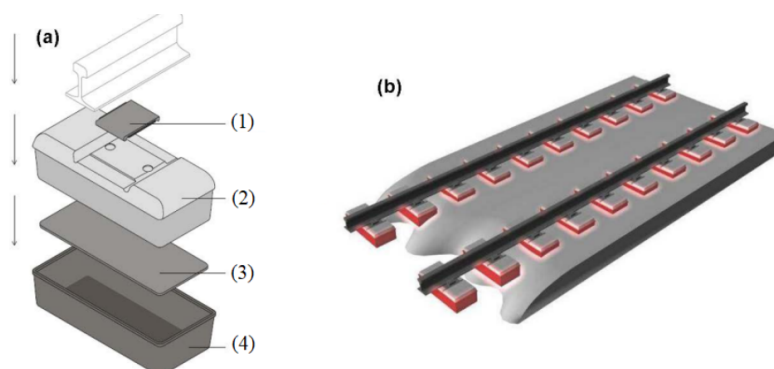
a) Système de support constitué de (1) semelle sous rail, (2) blochet, (3) semelle sous blochet, (4) chausson en caoutchouc. (b) Voie ferrée complète installée sur une dalle en béton non armé.
